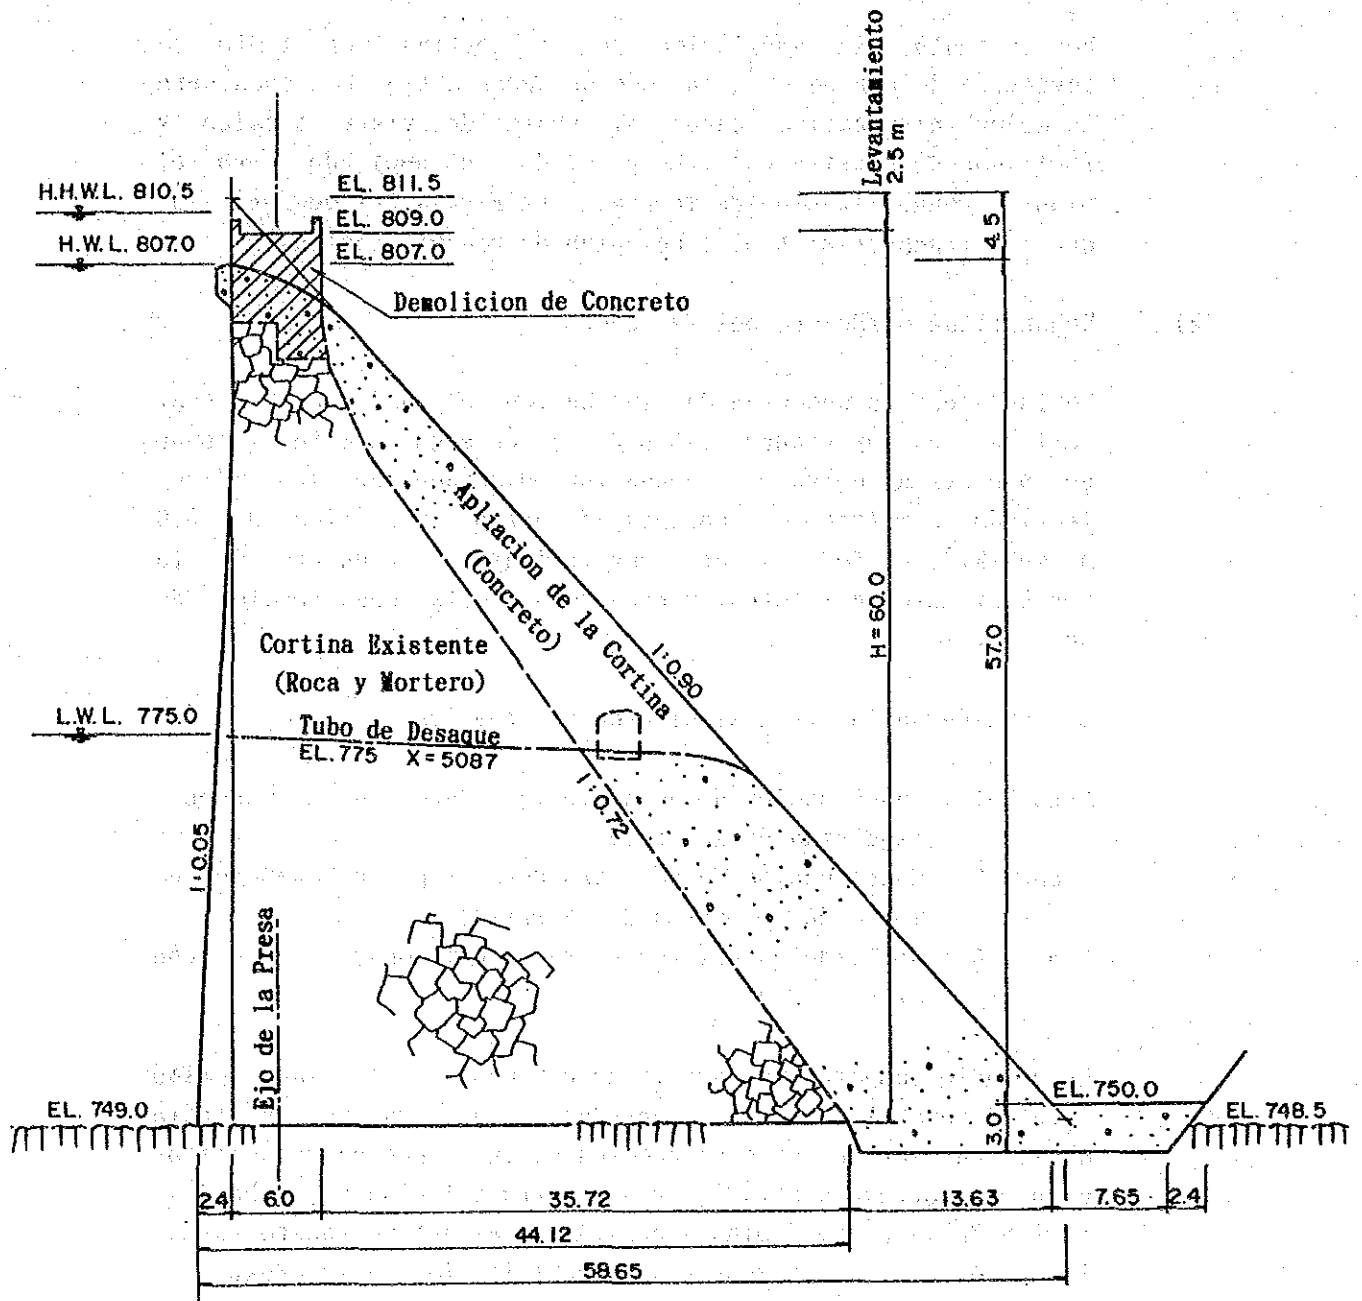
Sección Longitudinal Típica del Plan de Rehabilitación de la Presa
